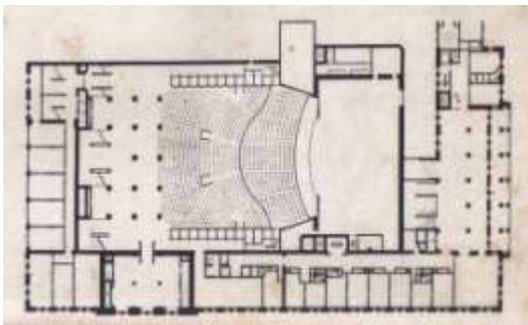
Auditorium Building, Chicago. Adler e Sullivan (1887-89). Planta baixa.
